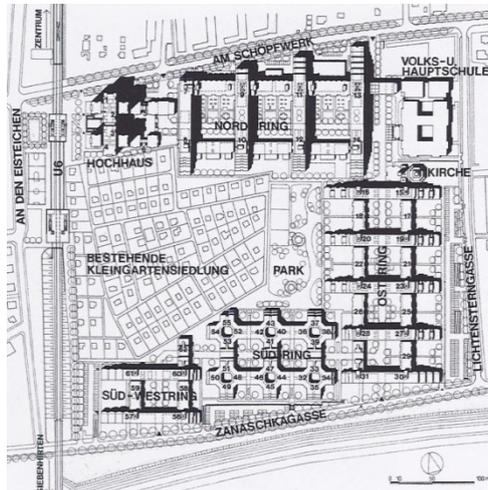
Wohnhausanlage "Am Schöpfwerk", Lageplan
